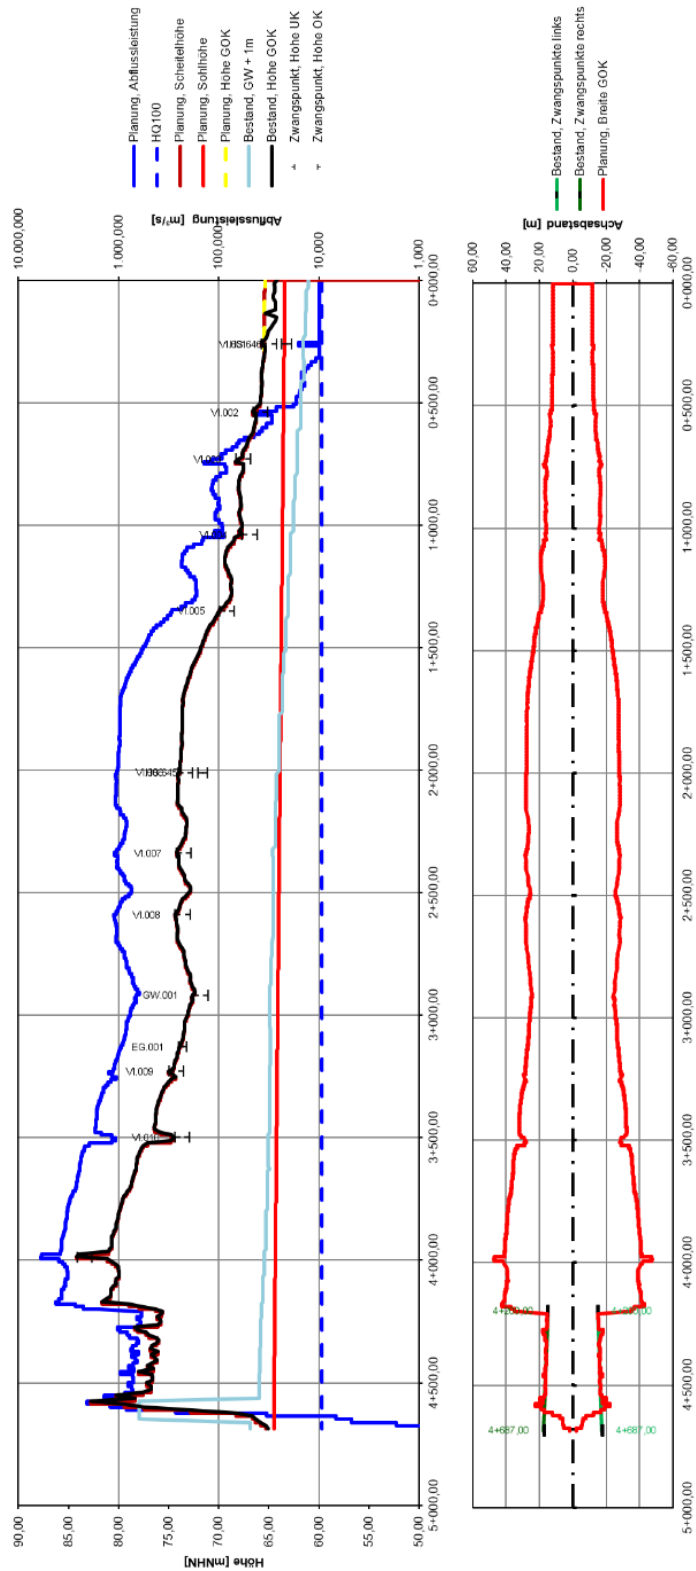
Längsschnitt (links) und Grundriss (rechts) der Variante Ahe-Nord (2.2) (vgl. Anlage A-5.1).
